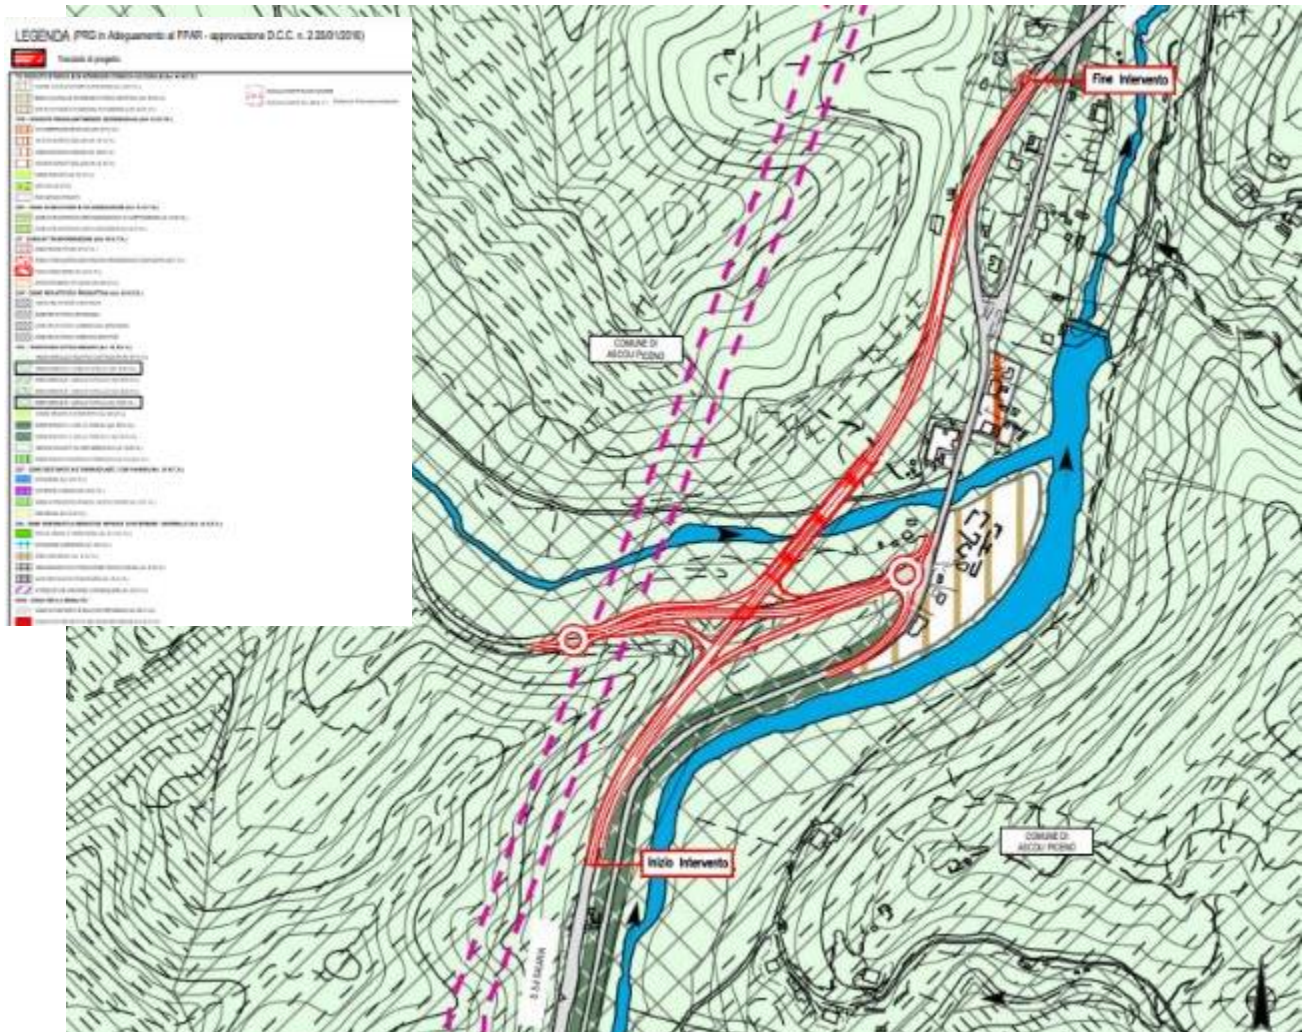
Stralcio da PRG, Zonizzazione di progetto
